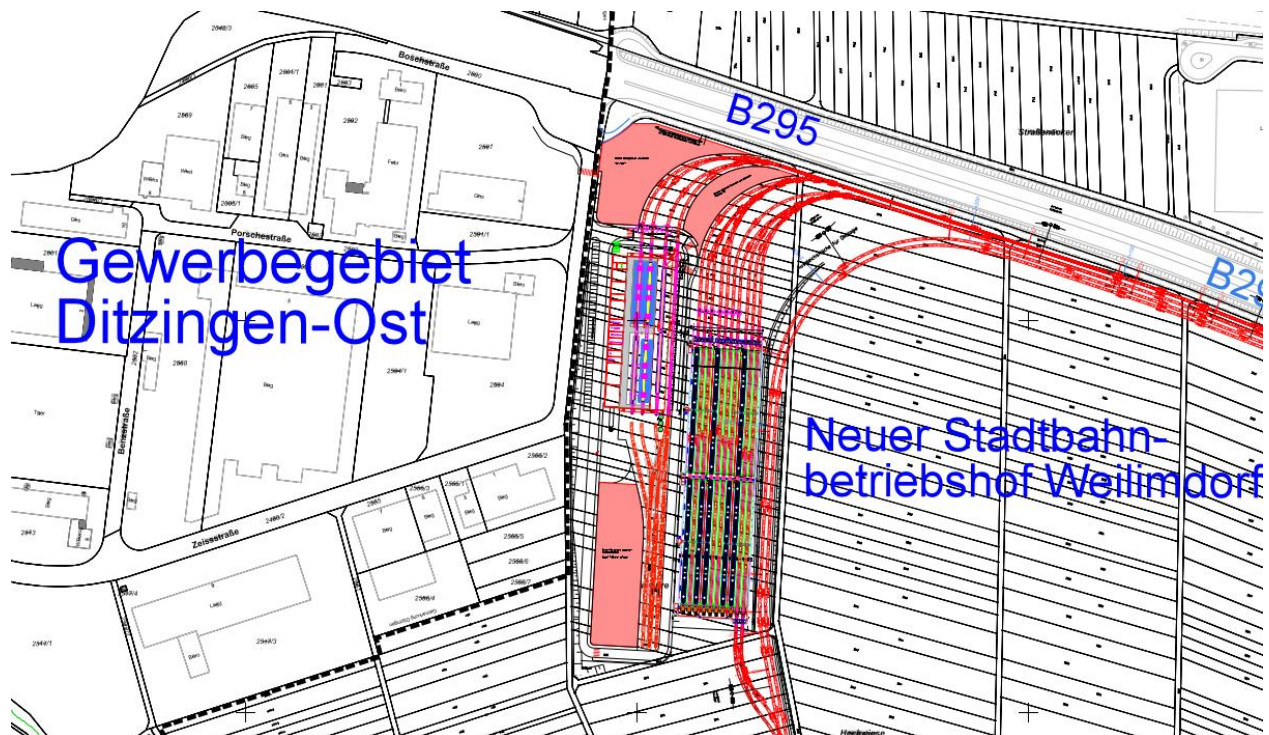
Ausschnitt aus Lageplan [1], unmaßstäblich
